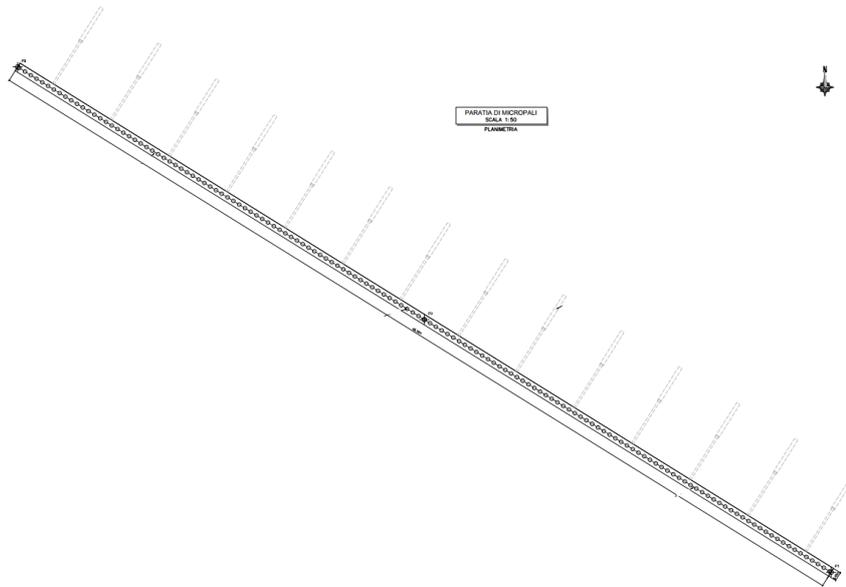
Andamento planimetrico dell'opera di sostegno
